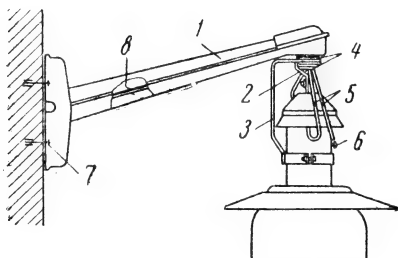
Установка светильника с лампой накаливания на кронштейне У114 на стене с креплением светильника держателем У115.
